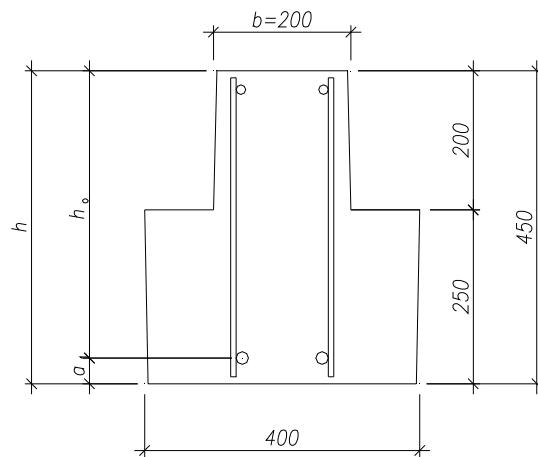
Расчетное сечение ригеля в месте обрыва арматуры
